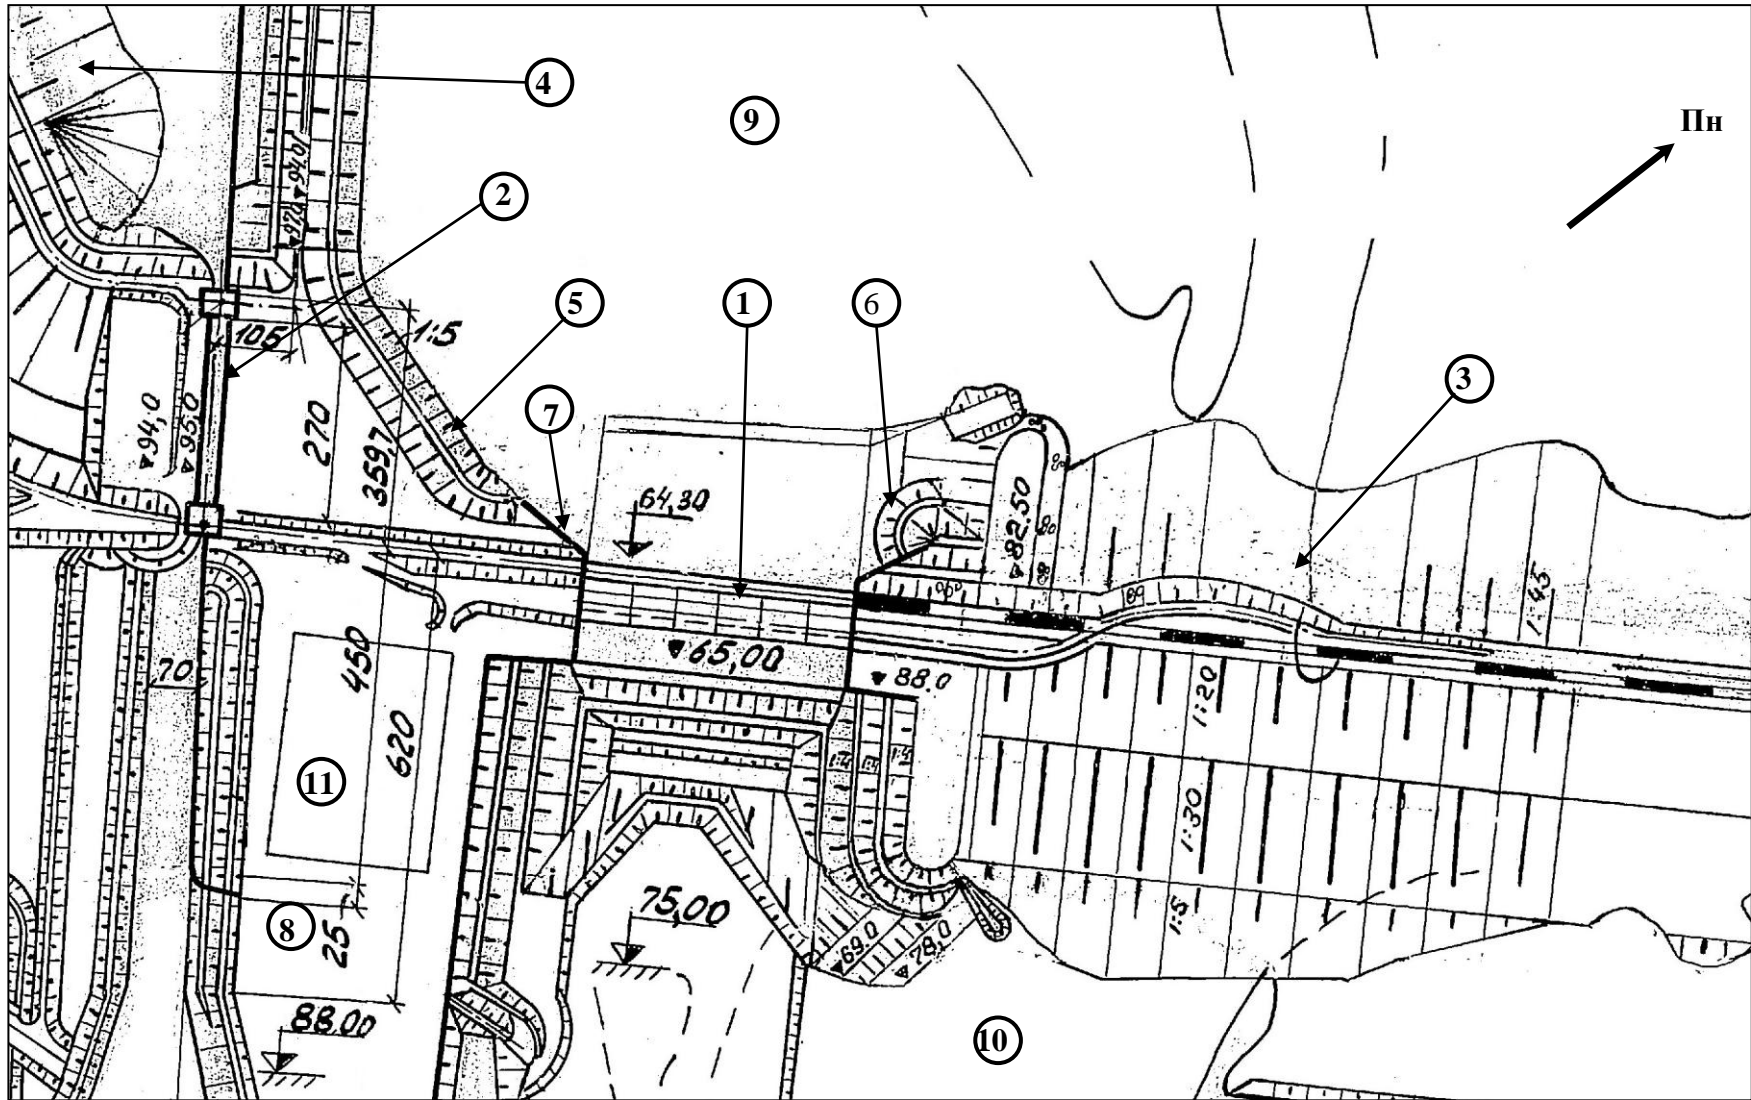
Фрагмент плану Канівського гідровузла: 1 – будівля гідроелектростанції; 2 – шлюз; 3 – лівобережна гребля; 4 – правобережна гребля; 5 – земляна вставка між шлюзом і будівлею гідроелектростанції; 6 – лівобережний стоян; 7 – правобережний стоян; 8 – роздільна дамба; 9 – Канівське водосховище; 10 – нижній б'єф; 11 – відкритий розподільний пристрій (розміри в м.)
